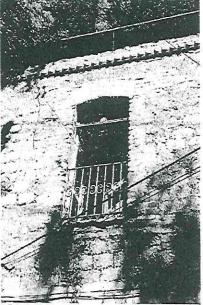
Fachada del inmueble ubicado Guillermo Prieto 79.
